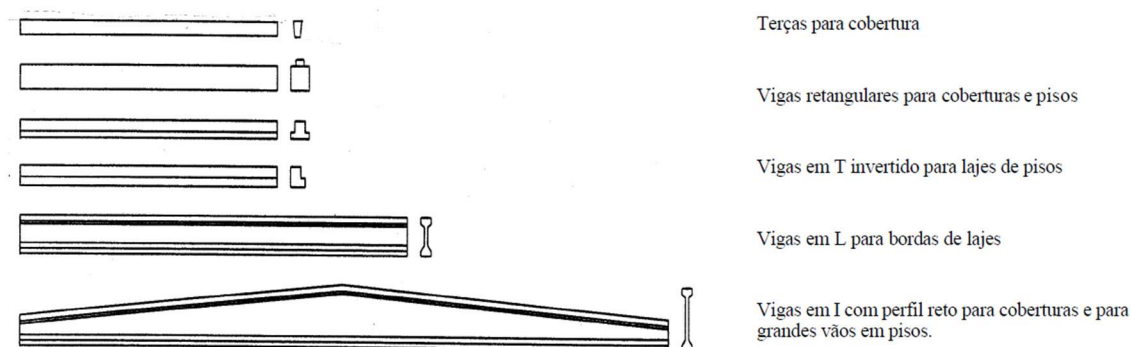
Tipos de vigas e suas seções transversais (Acker, 2002)
